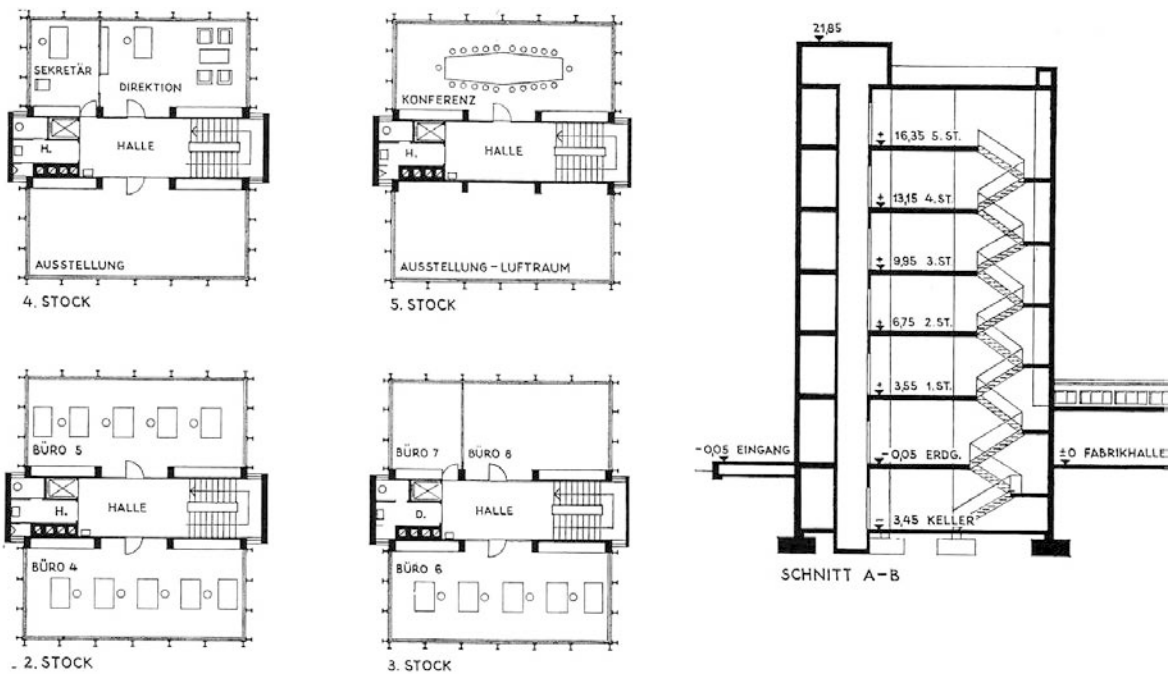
Bürohaus Grundrisse und Schnitt. (SBZ, Heft 24, 1964)
